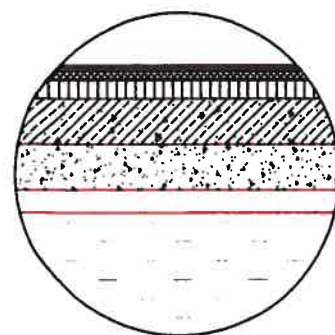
Detail A - STUDIED ROAD STRUCTURES / Detaliu A - STRUCTURI RUTIERE STUDIATE
